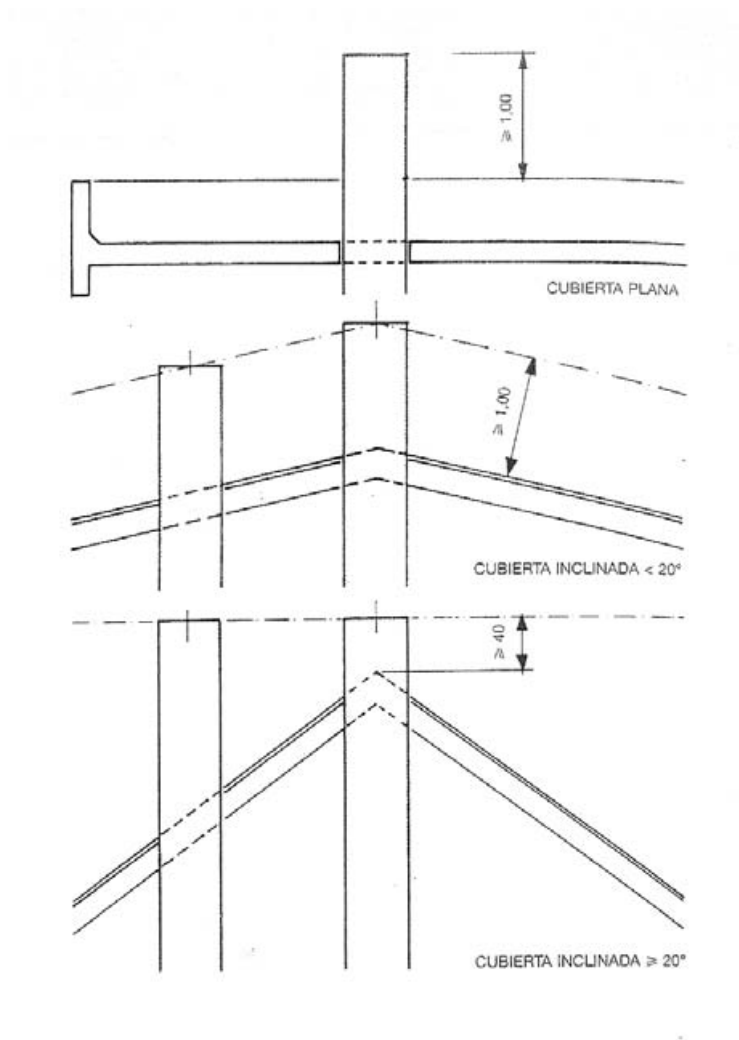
Cubierta Plana; Cubierta Inclínada < 20°; Cubierta Inclínada >20°.
